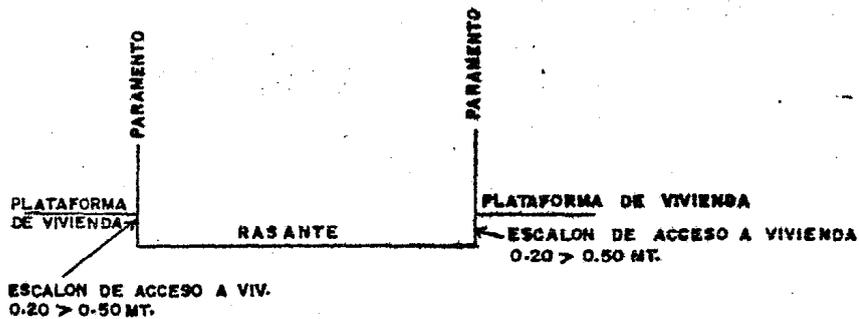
SECCION TRANSVERSAL EN ANDADORES
